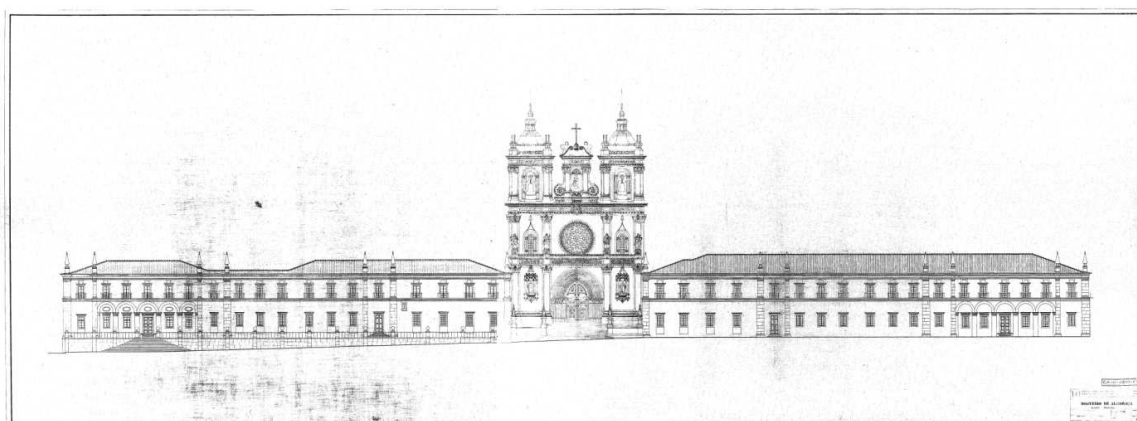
Ala Norte - Fachada da Igreja - Ala Sul (Arquivo da DGPC).
